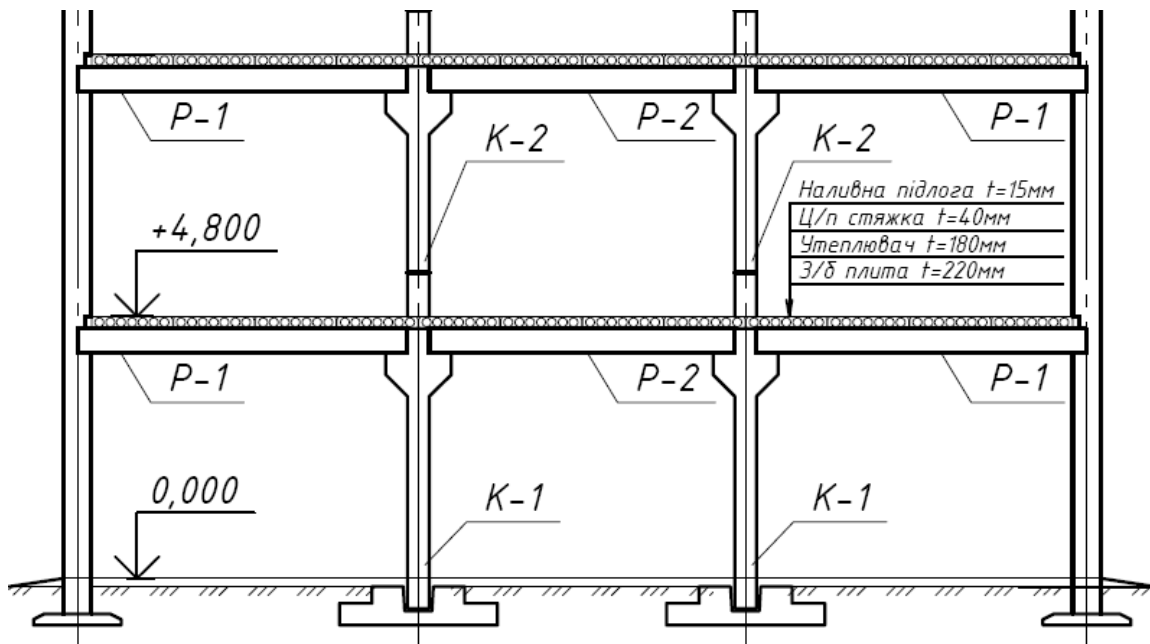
Фрагмент поперечного розрізу збірної будівлі.
